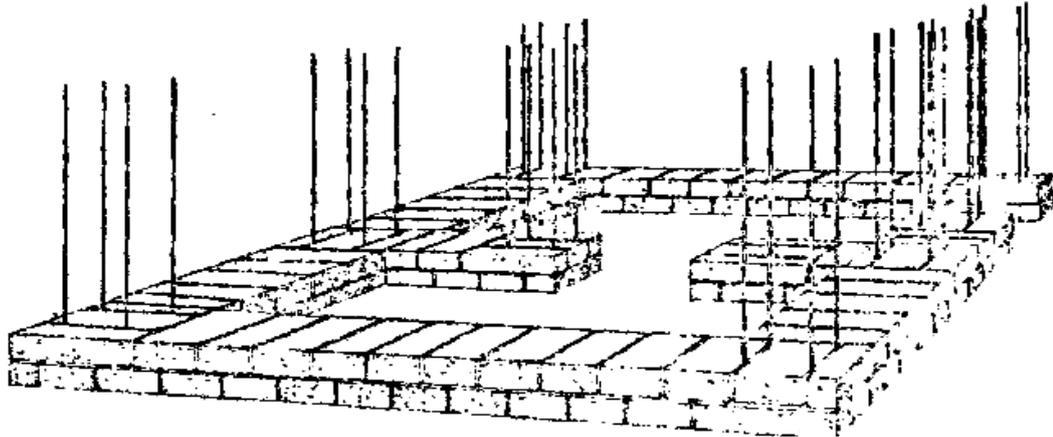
Aparejo en vivienda con refuerzo vertical
